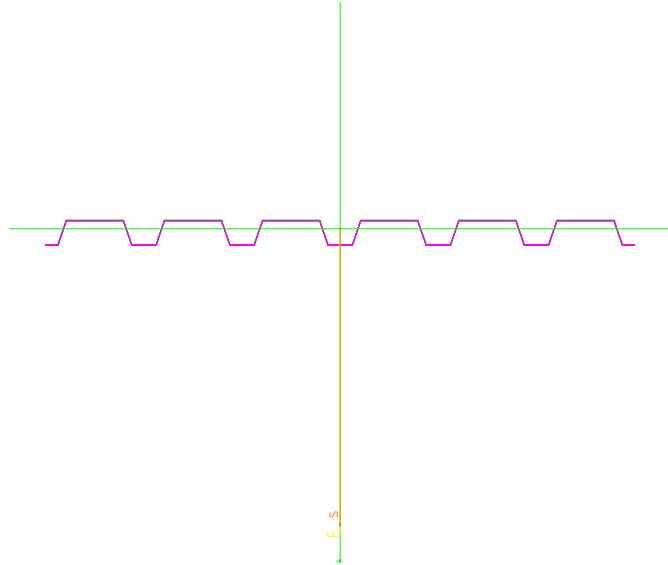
Cálculo área e inercia en AutoCAD (Steel Deck).
